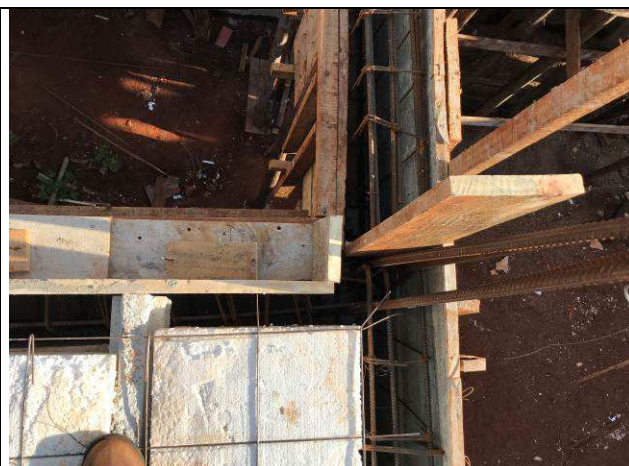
C: Formas e armaduras das vigas e lajes da cobertura - junta de dilatação.
